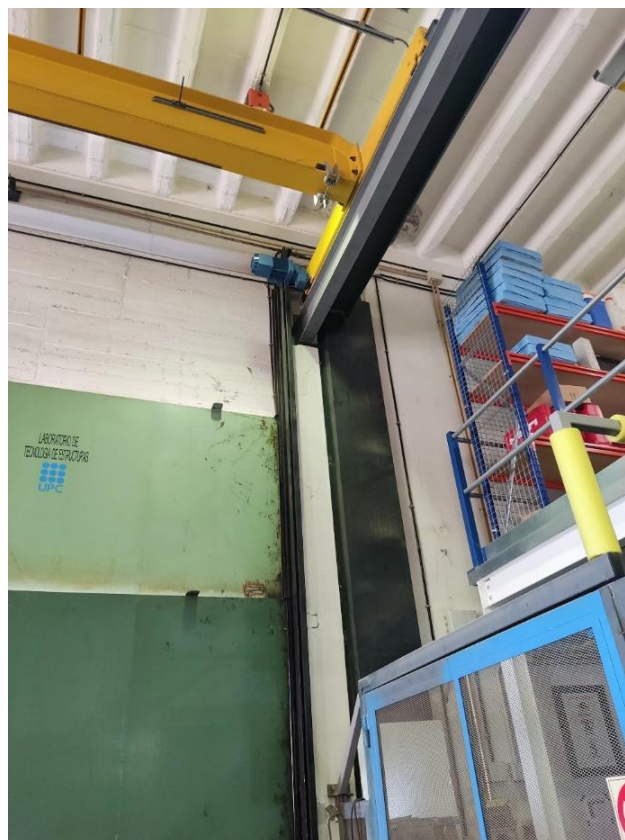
Apoyo de la viga carrilera en la intersección de los ejes 19 y B.
